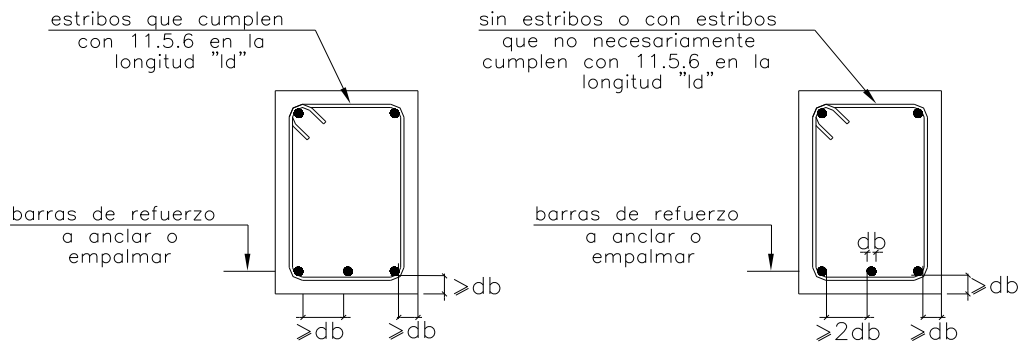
Condiciones para la longitud de desarrollo (Tabla 12.1) de barras en tracción
